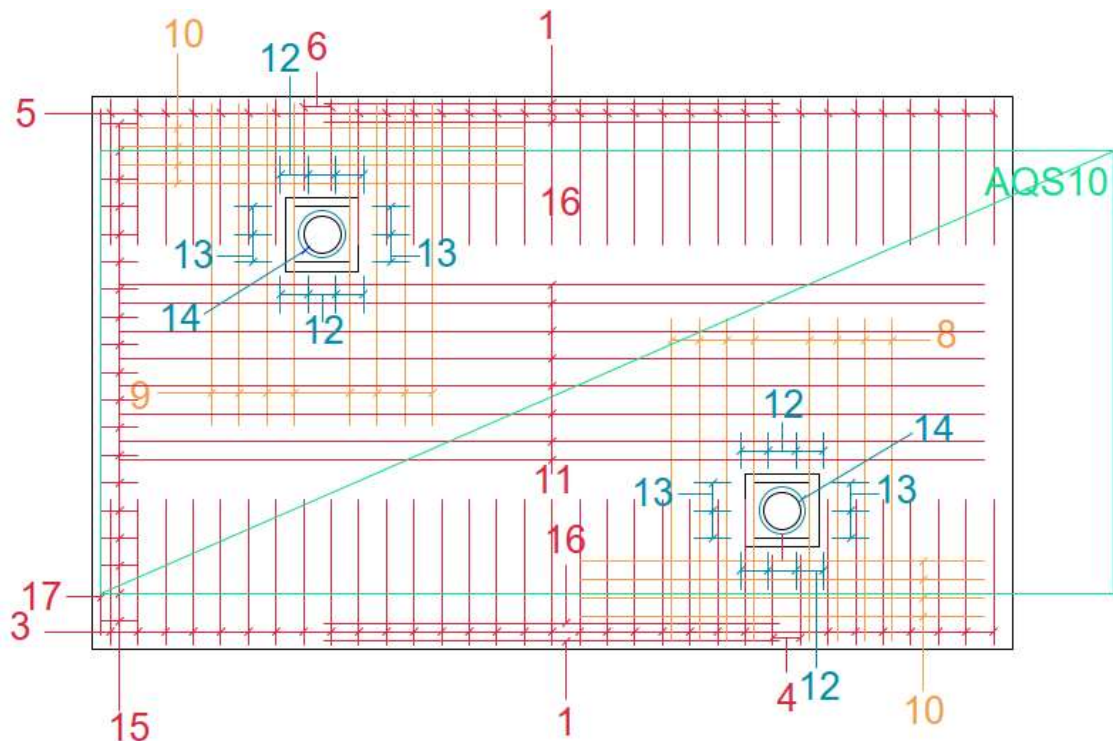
Bewehrungsplan Ankerwand Treglwang Element A2
